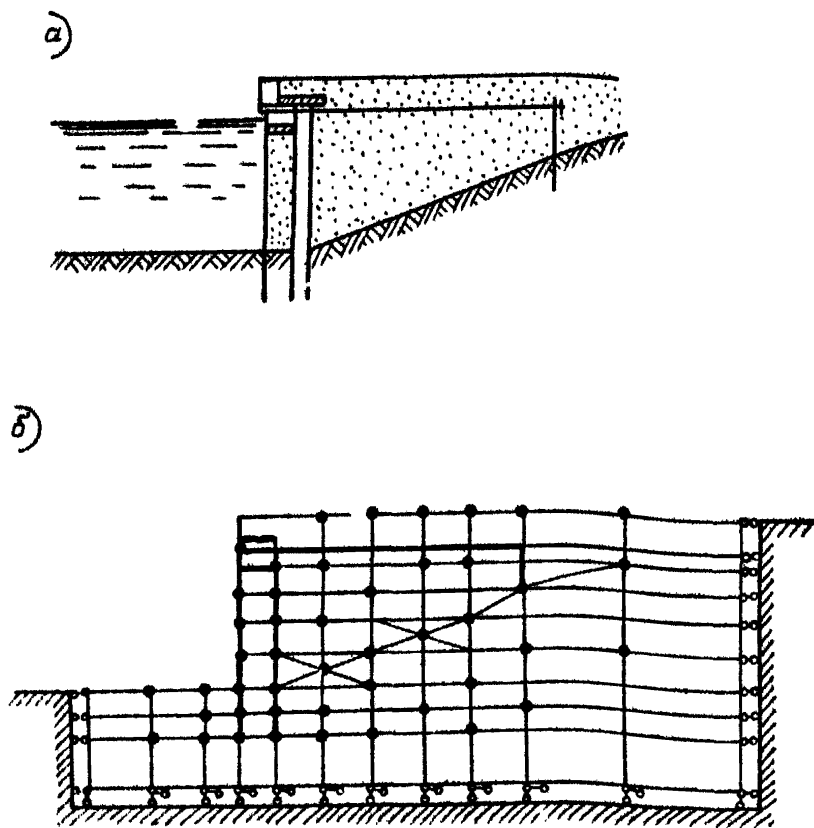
Расчетная схема экранированного больверка: а – разрез причала; б – расчетная схема по МКЭ
